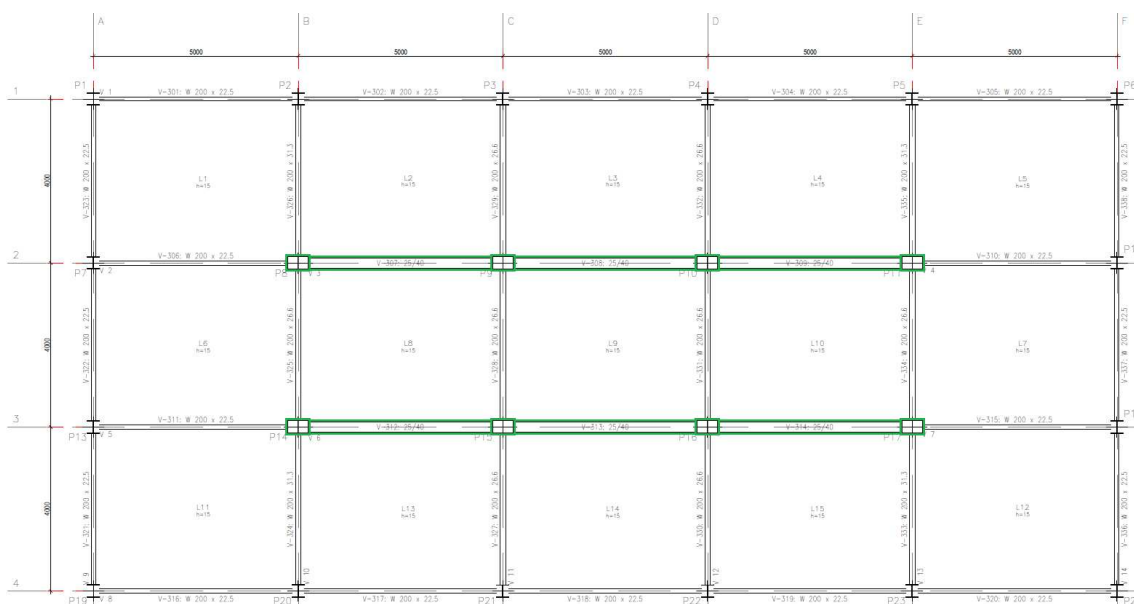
Vigas pavimentos 6 até 10 (estrutura associada 02)
